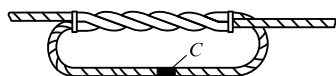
Соединение проводов соединителем и термитной сваркой
